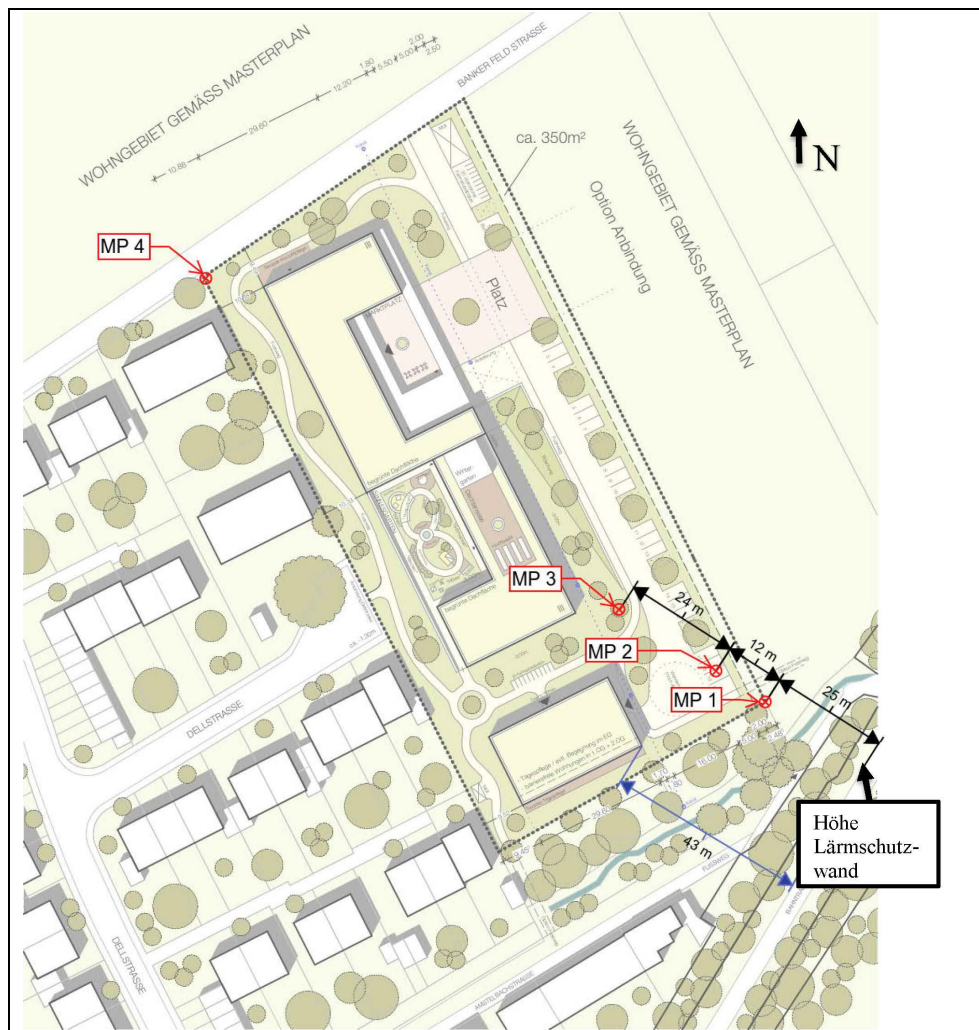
Lageplan mit Position der Messpunkte und den Abständen zur Gleisanlage
